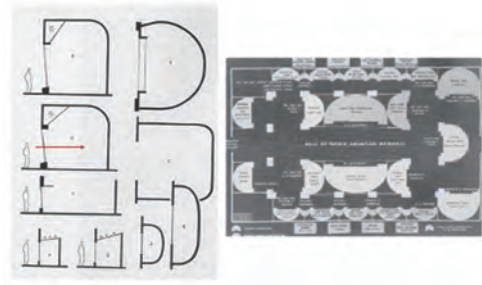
アメリカ自然史博物館のジオラマの断面図と平面図
